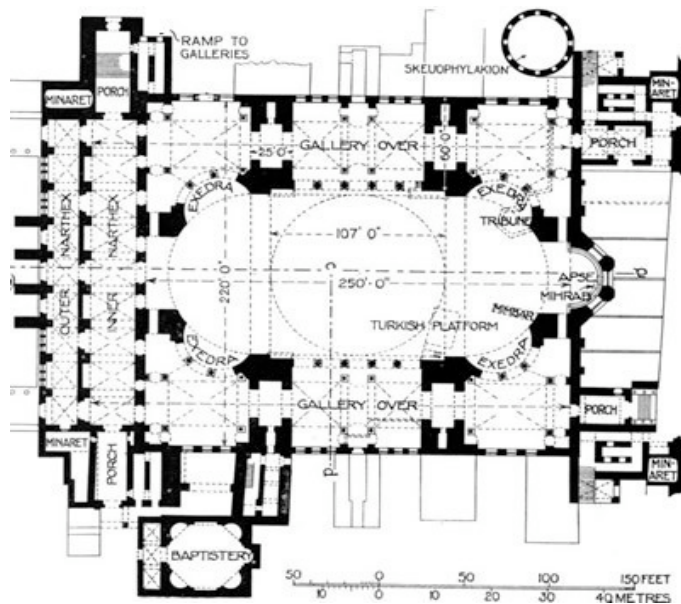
Planimetria della chiesa di Santa Sofia in cui è chiaro l'impianto centrale dilatato dalle due esedre laterali.
